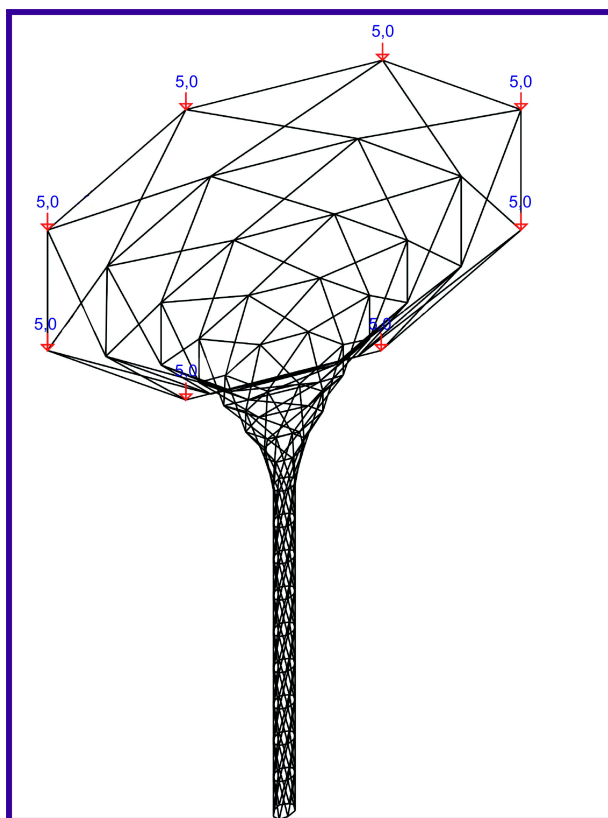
Схема распределения нагрузок на узлы верхнего пояса колонны
